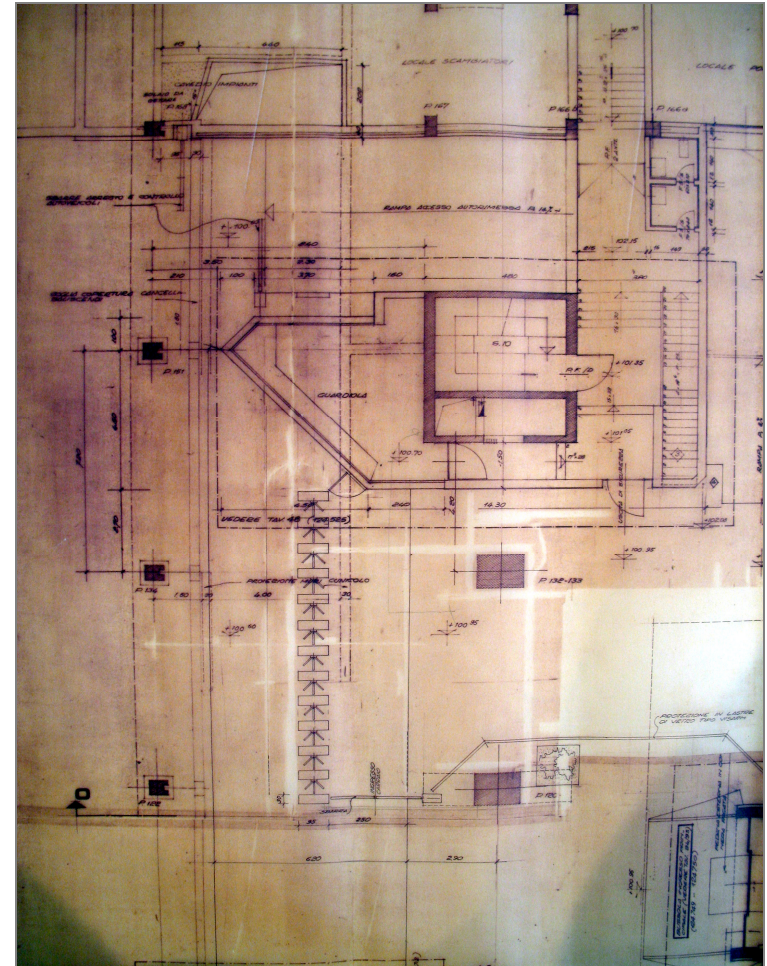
tornelli ingresso principale – pianta (fonte CSAC – stralcio tav. 118, archivio n. 384-3)
